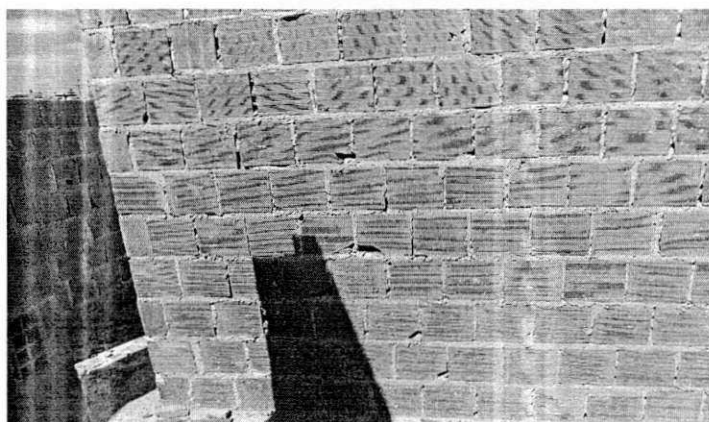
Alvenaria de vedação interna do bloco 13.
